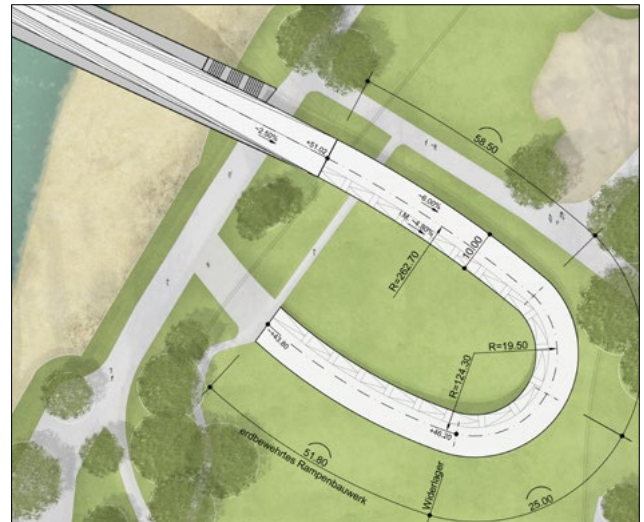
Grundriss rechtsrheinische Rampe
